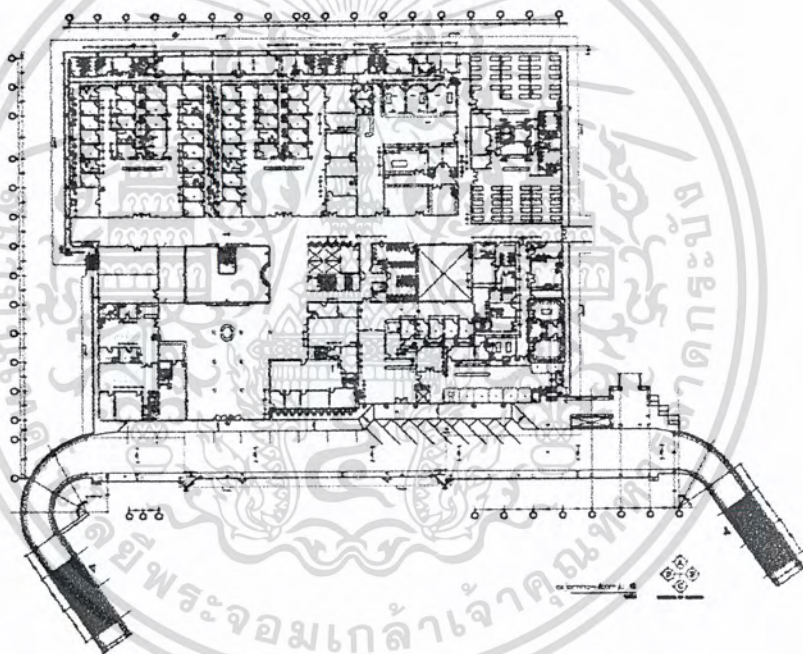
แสดงแปลนพื้นที่ชั้นล่าง GROUND FLOOR PLAN
